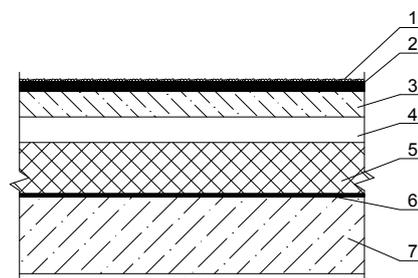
Вентилируемая (двухоболочковая) кровля: 1 – защитный слой; 2 – водоизоляционный ковер; 3 – верхняя несущая конструкция; 4 – воздушная прослойка (технический этаж); 5 – теплоизоляционный слой; 6 – пароизоляция; 7 – нижняя несущая конструкция
